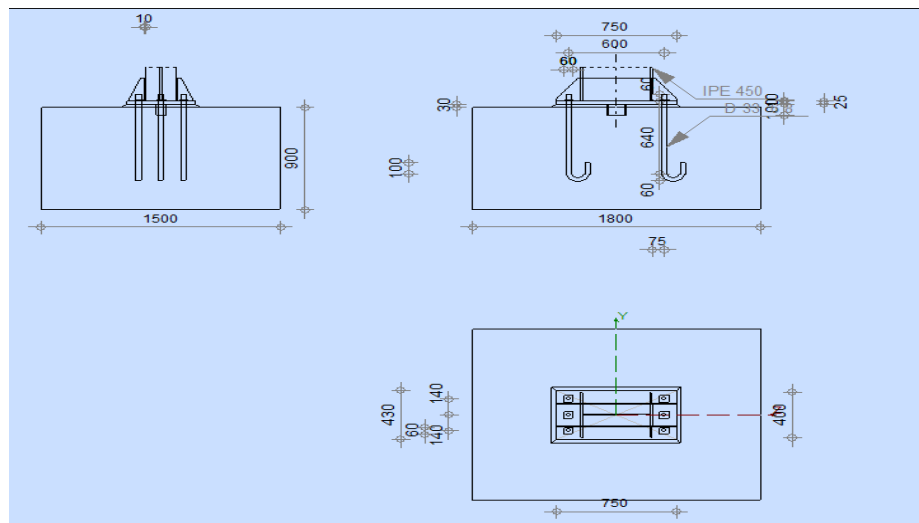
Détail de l'assemblage au niveau du pied de poteau
